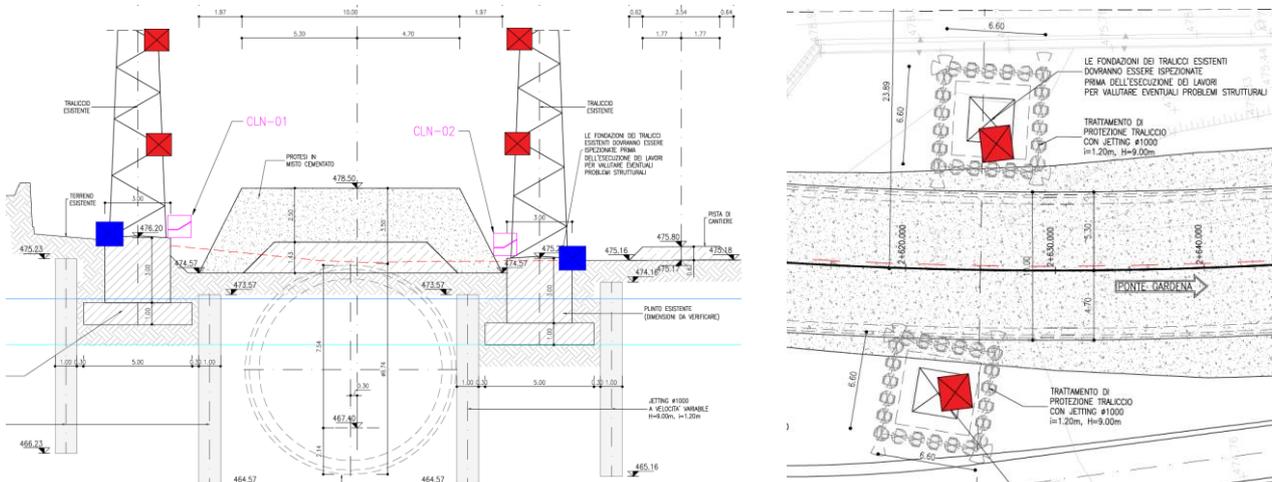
Sezione e pianta dei tralicci dell' alta tensione
